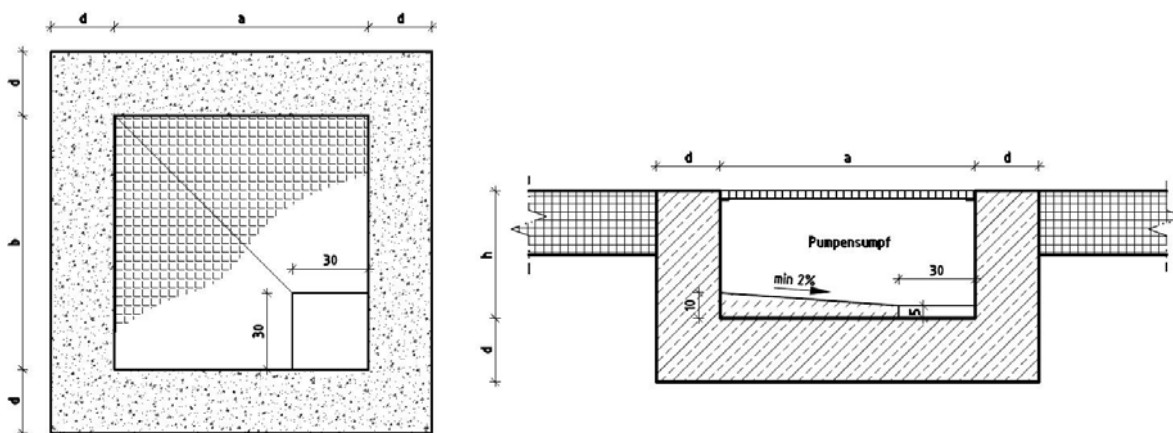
Grundriss und Schnitt Ausbildung Pumpensumpf
